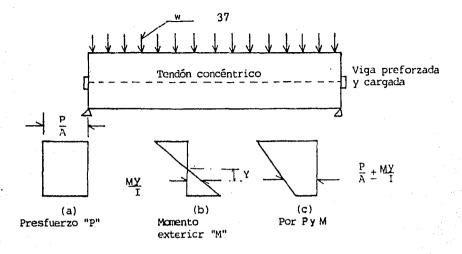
Distribución de esfuerzos a través de una sección de concreto presforzado concéntricamente.
